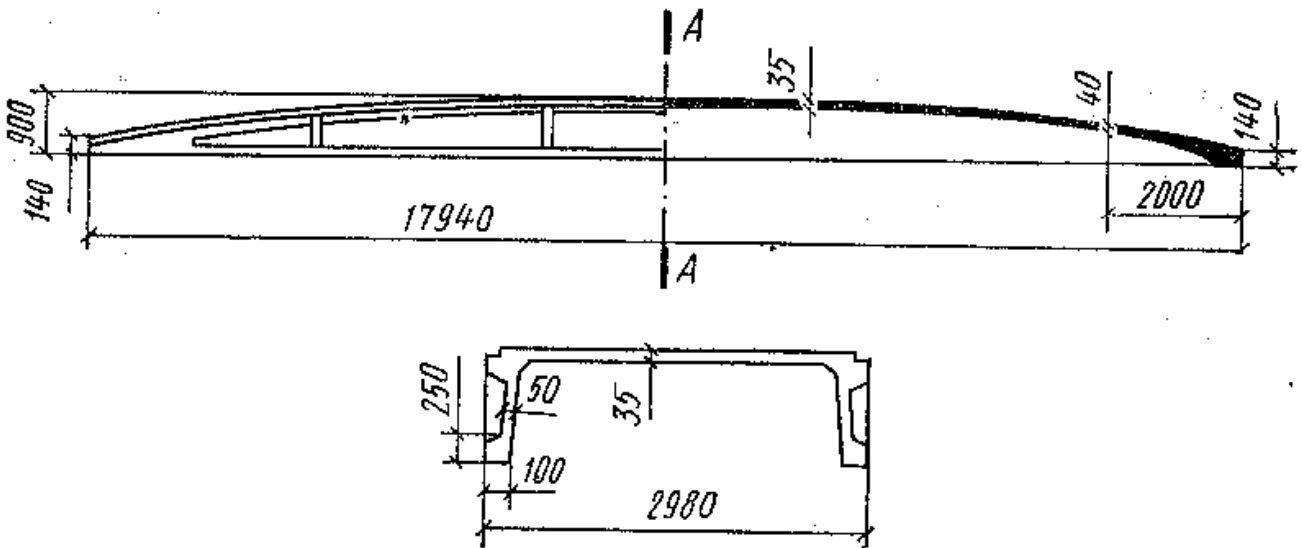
Схема крупноразмерной железобетонной сводчатой плиты КЖС размером 3x 18 м
